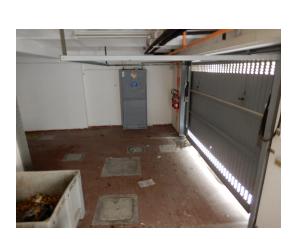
Armadietto metallico posto nell'autorimessa contenente lo sgancio elettrico generale.
